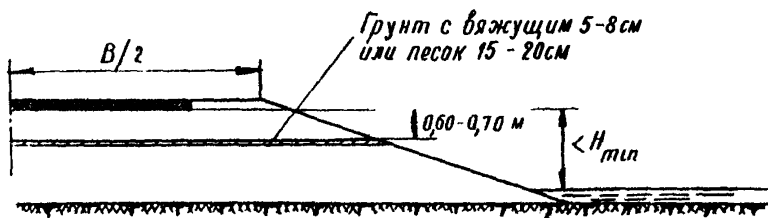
Конструкция земляного полотна на мокрых солончаках при невозможности минимального возвышения дорожной одежды над уровнем грунтовых вод или длительного стояния воды.
